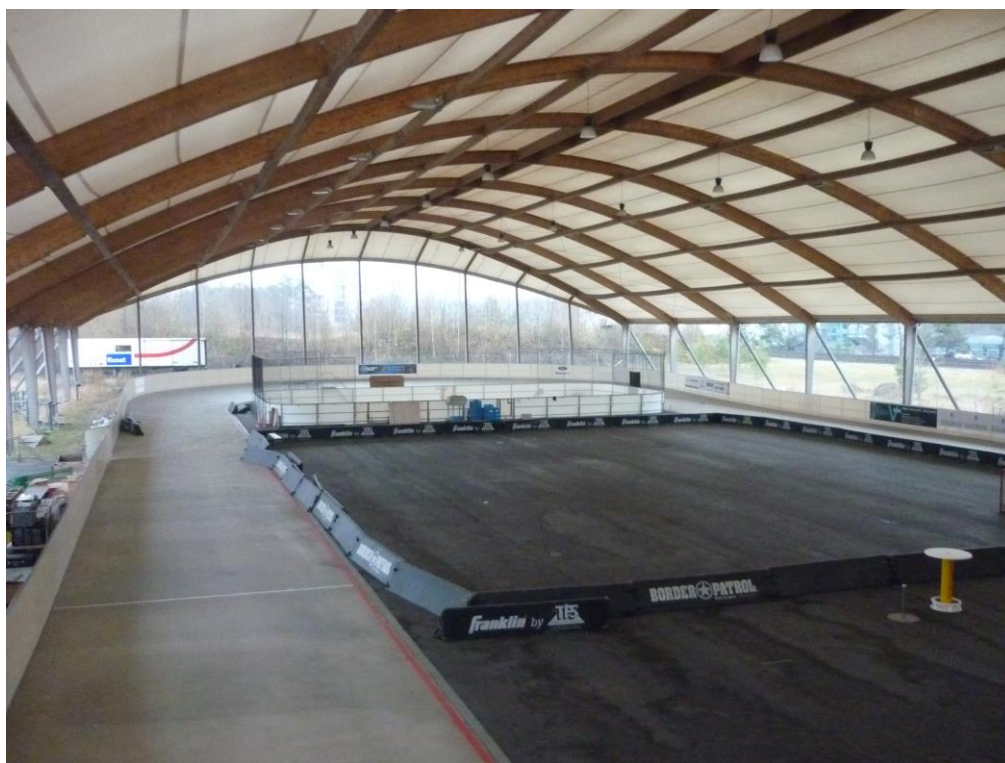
Innenbereich Inlinedrom mit Rundbahn und befestigtem Innenbereich
